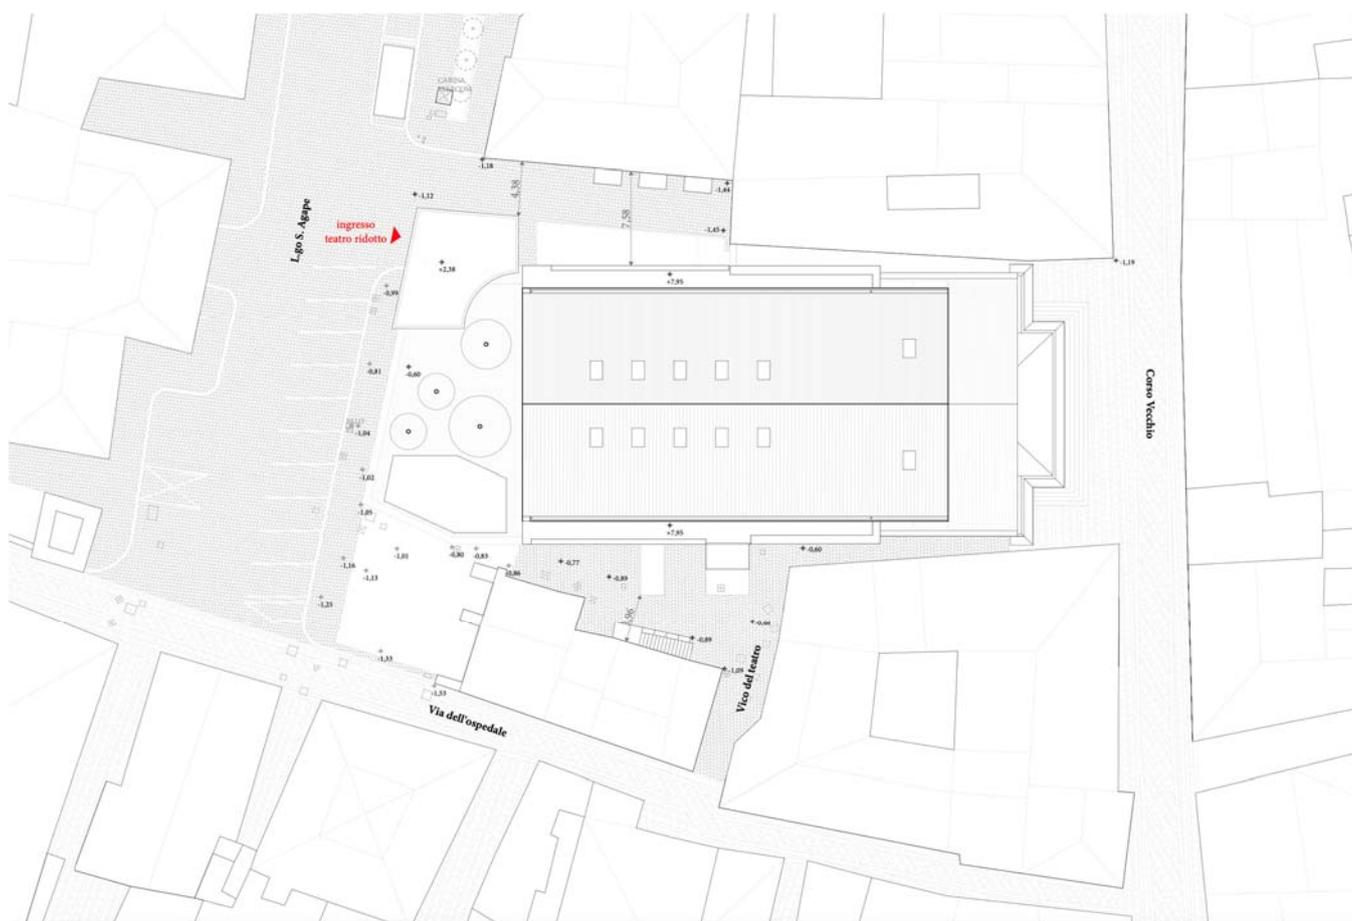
Planimetria generale dell'intervento e delle aree esterne
